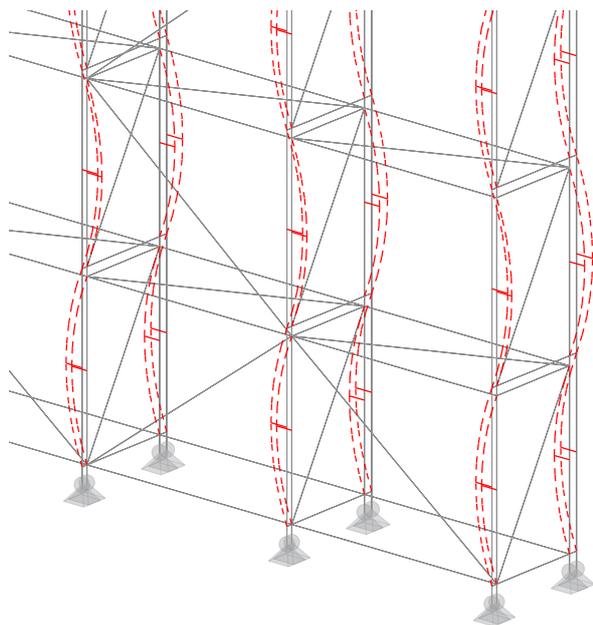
Mögliche „lokale“ Vorkrümmung eines Gerüstsystems (Ausschnitt)
